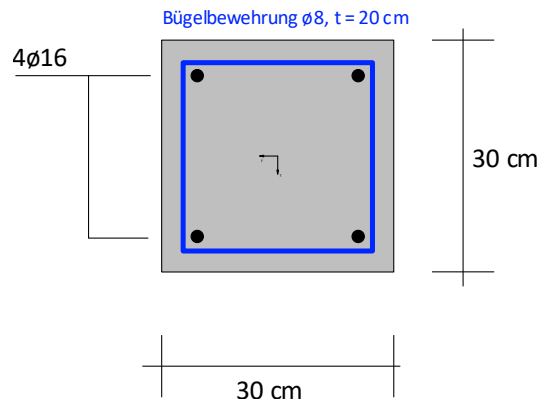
Geschätzte Bewehrung Betonstütze S1 Eingangshalle
